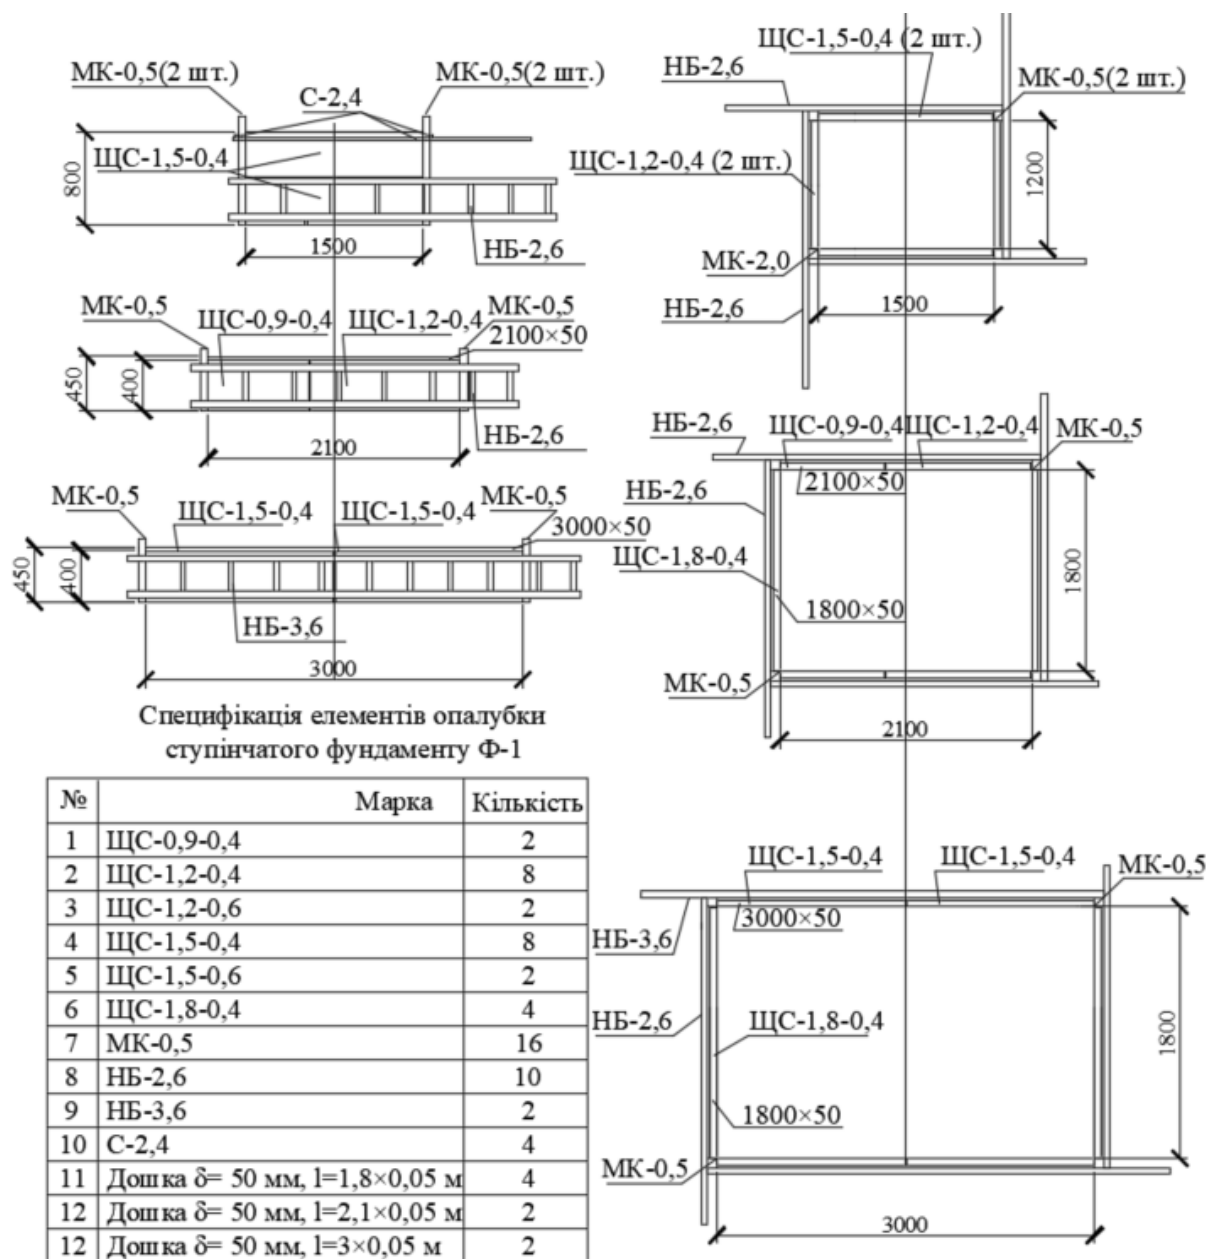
Маркувальна схема ступінчастого фундаменту зі специфікацією елементів опалубки
